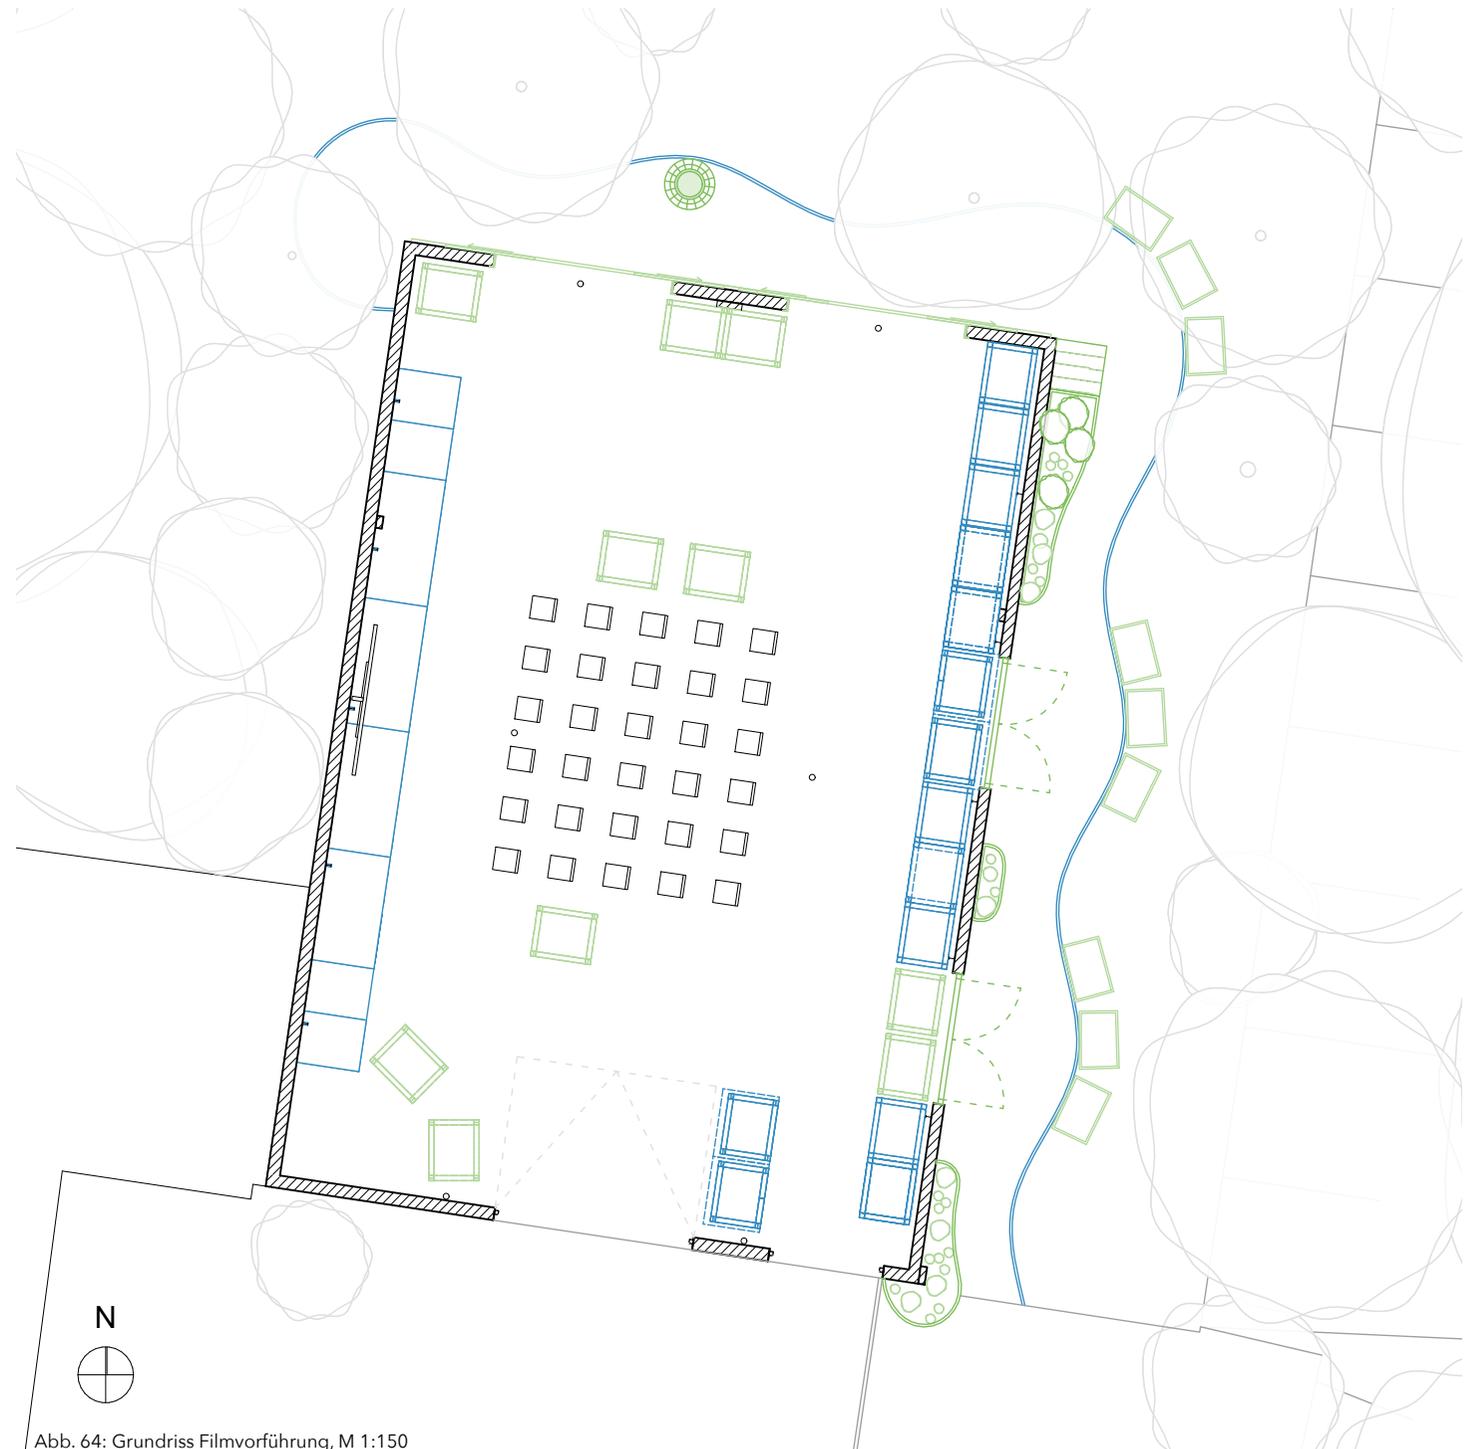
Grundriss Filmvorführung, M 1:150
